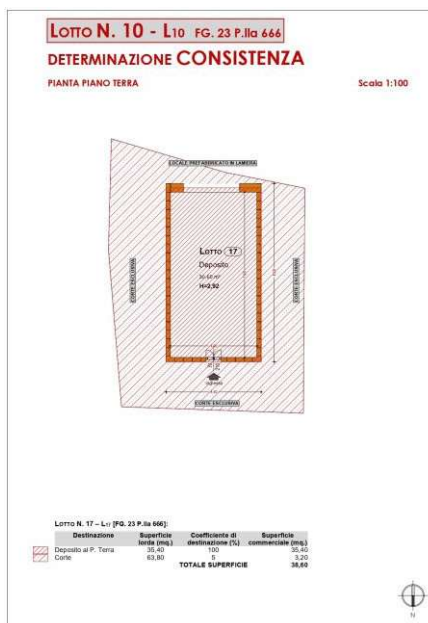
Determinazione consistenza Lotto L17 (ALL. 11).
